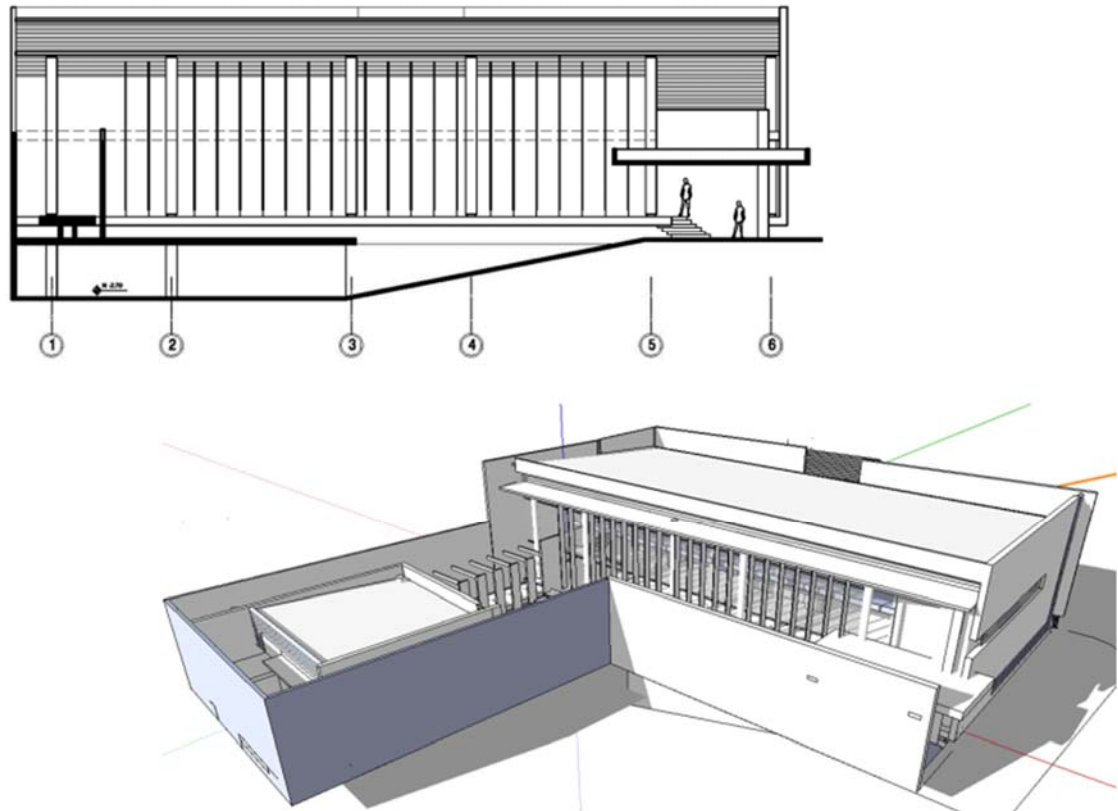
volumetría y fachada sur. Fuente: Elaboración Propia
